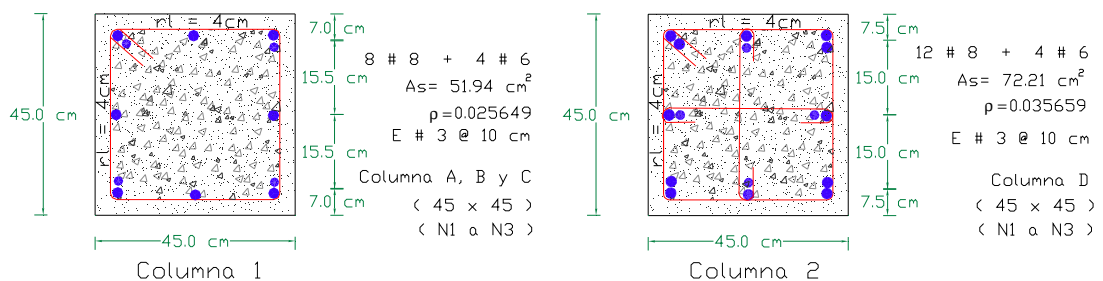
Dimensiones y armado de columnas, edificio I₃
